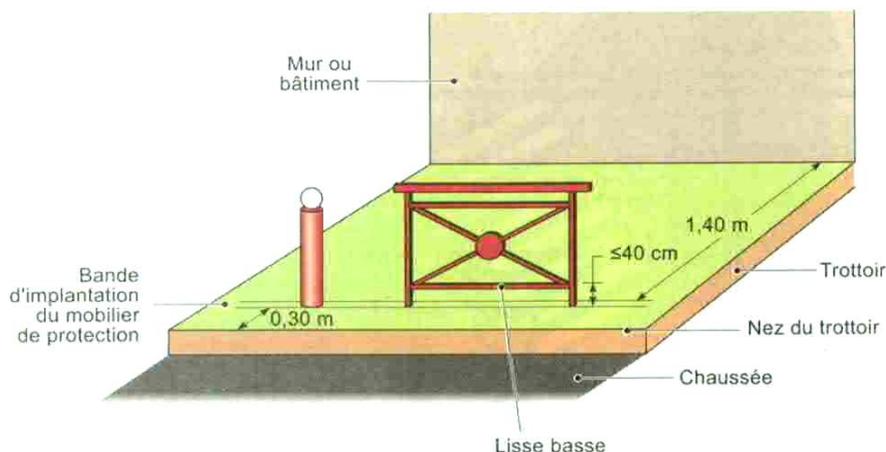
Exemple d'implantation de poteaux le long du trottoir.
